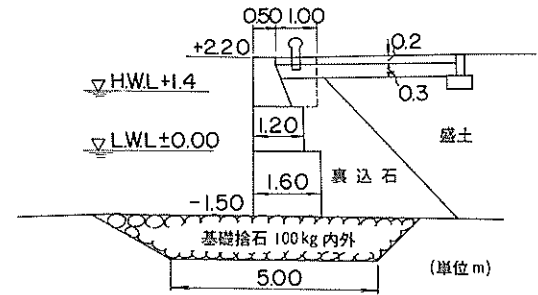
荻浜港荻浜物揚場(-1.5m)標準断面図
